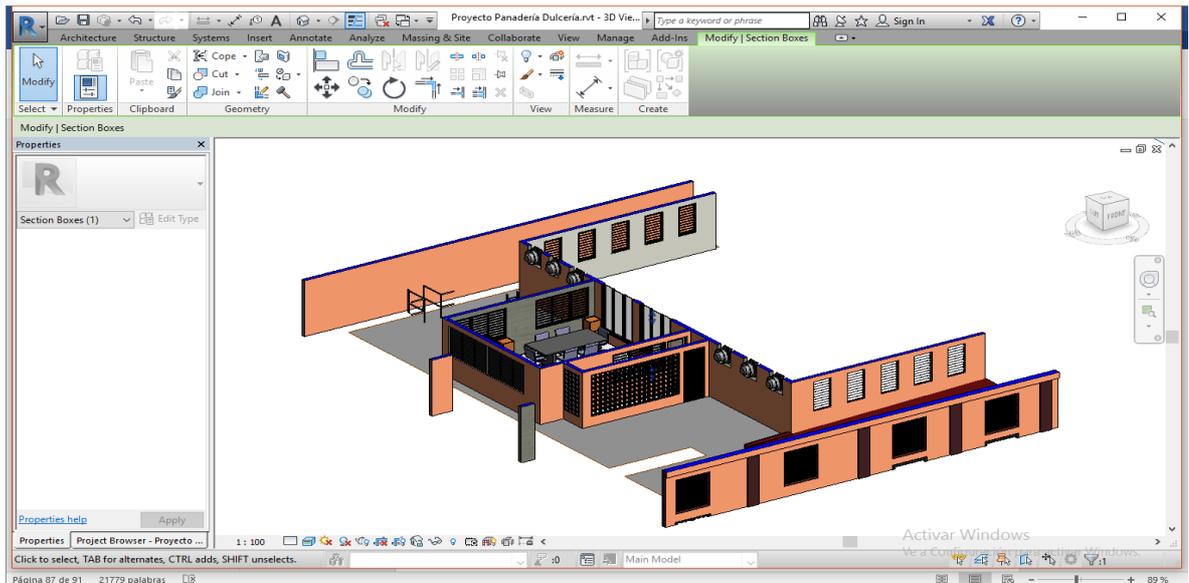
Vista 3D de la segunda planta. Fuente: Proyecto “Panadería Dulcería “Empresa IDEAR de Cienfuegos.
